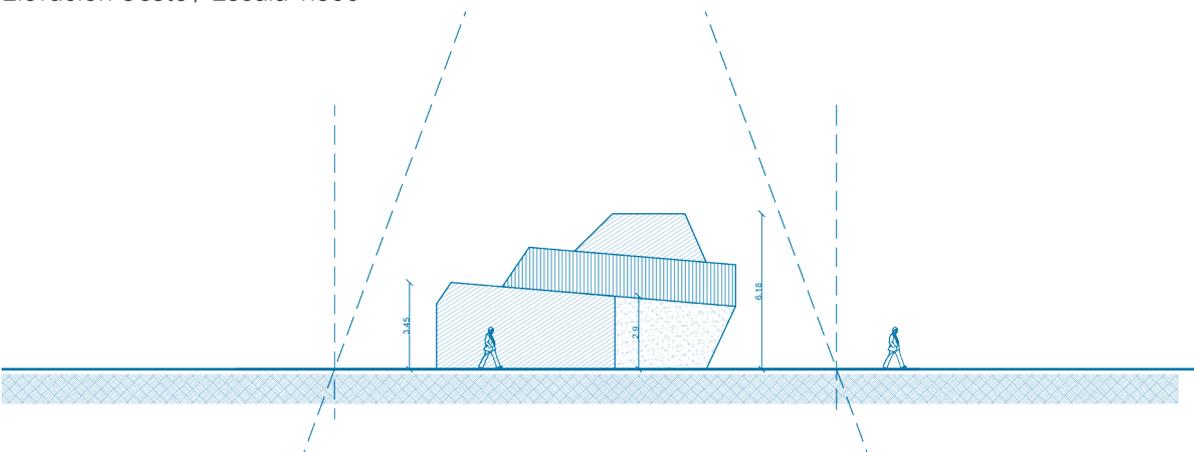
Planimetría Propuesta, lugar de culto. Caso 04
